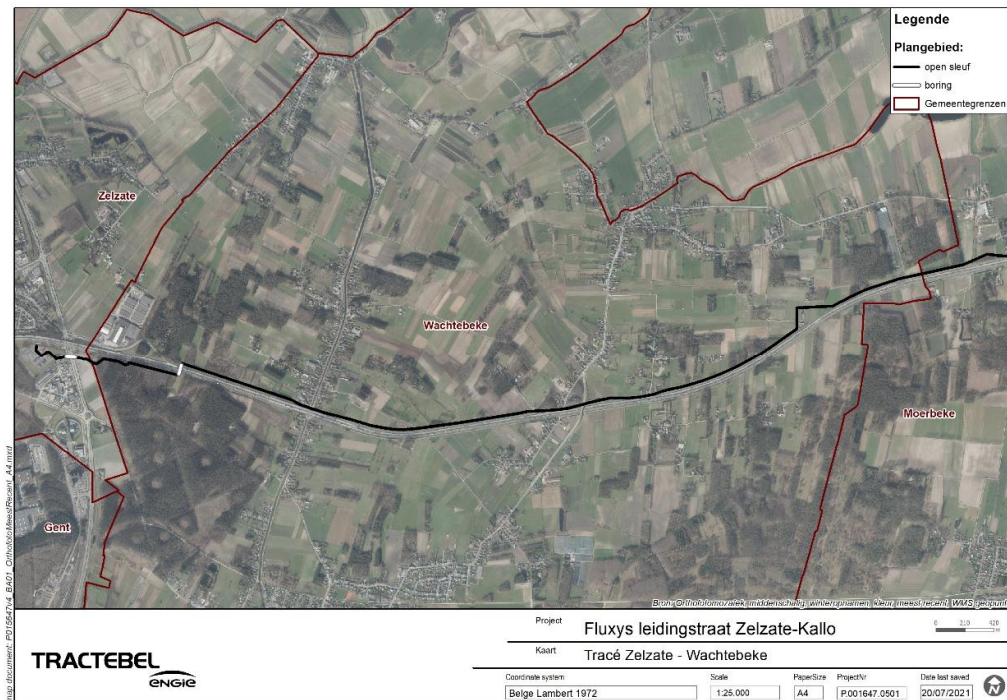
Planvoornemen – detail grondgebied Zelzate
